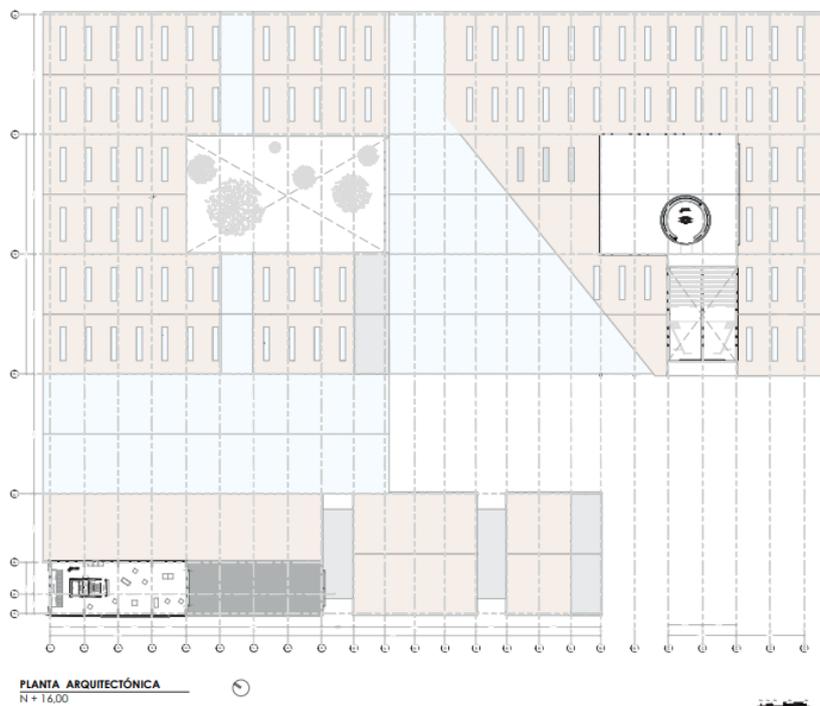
Planta arquitectónica N+16.00 Escuela de Artes - Museo
